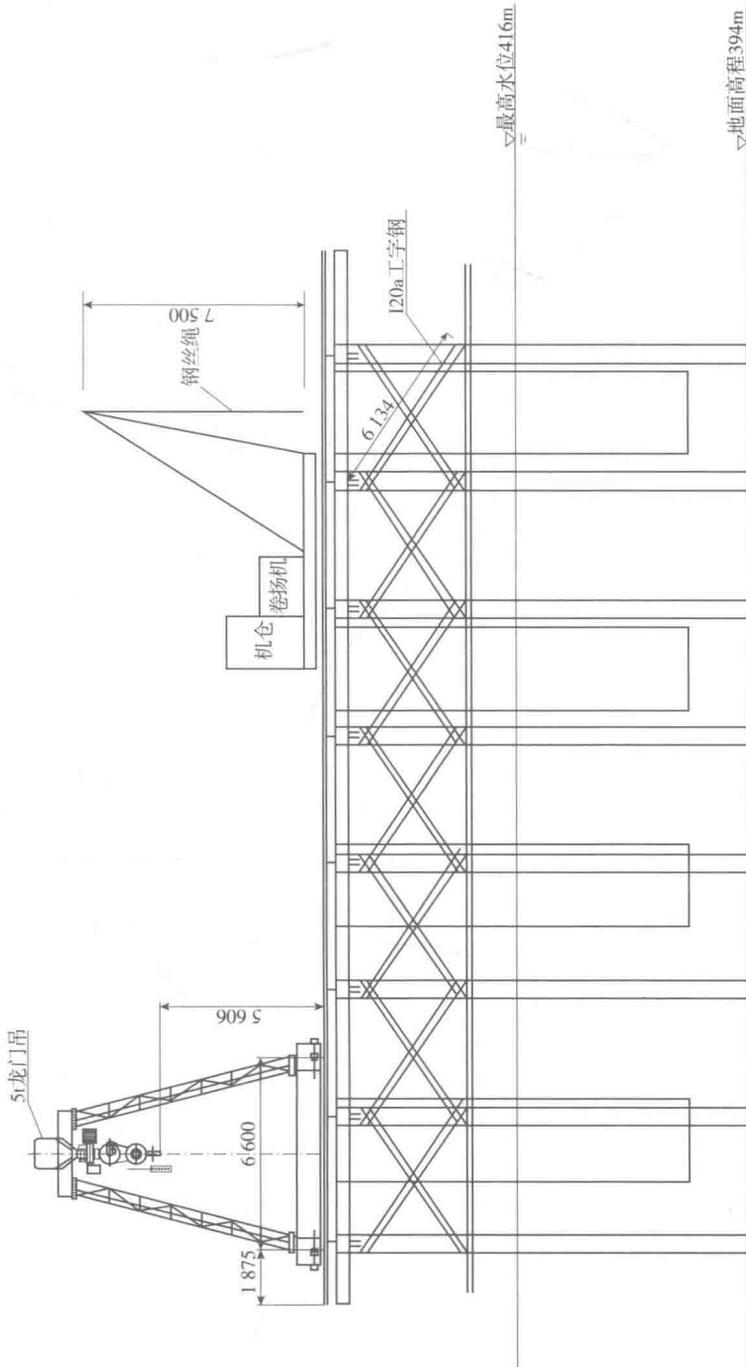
水上桩基钻孔平台体系立面图(尺寸单位:mm)
